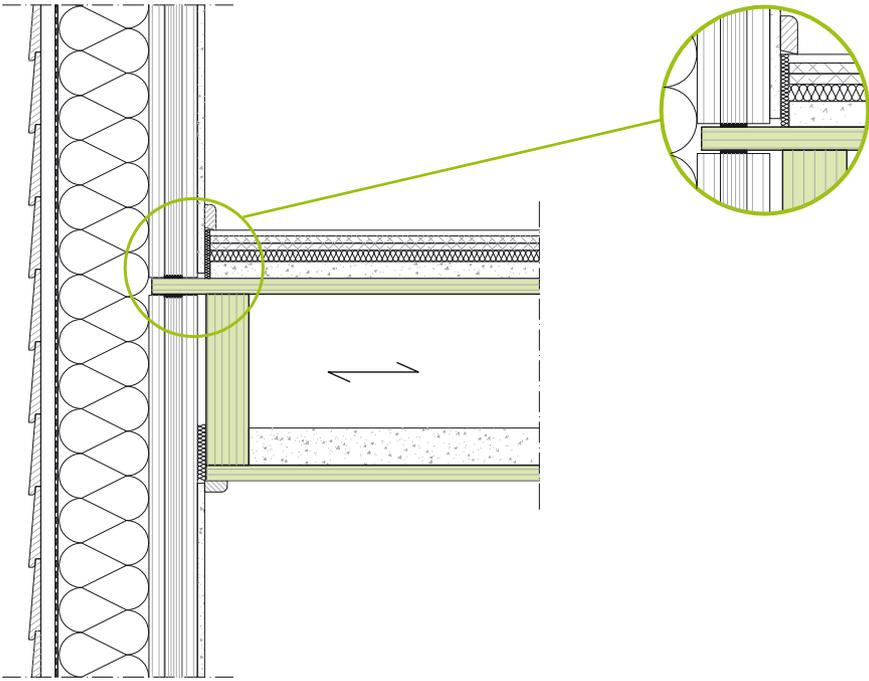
DETAIL: TRAUFE KERTO-KASTENELEMENT
